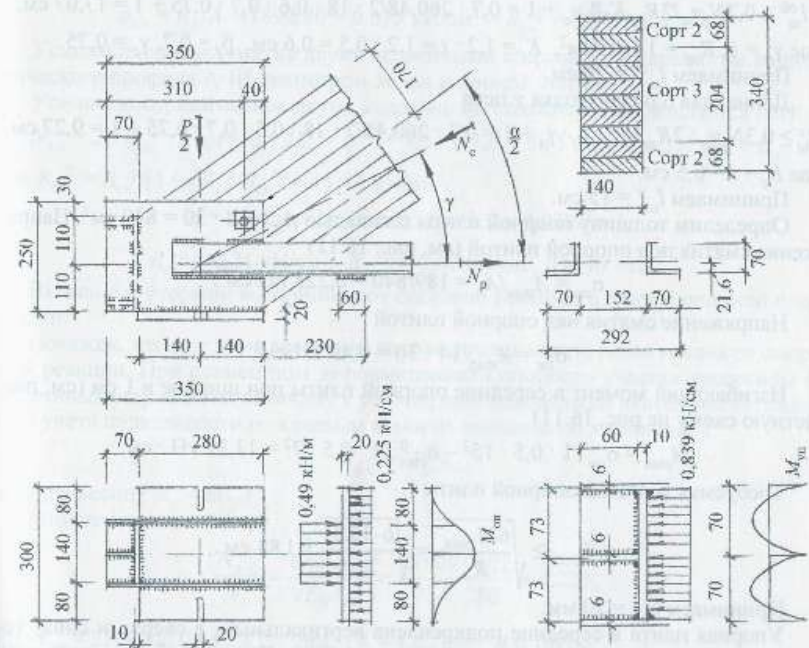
Опорный узел фермы и сварной башмак. Вариант 1
